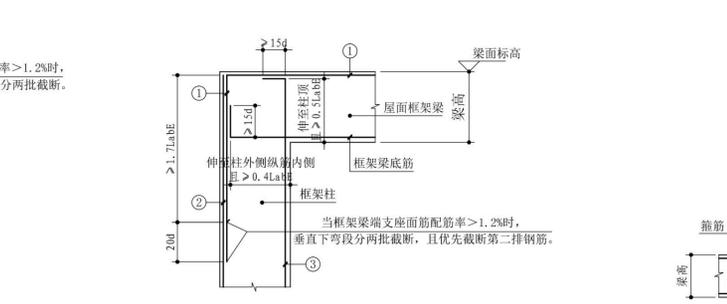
屋面框架梁纵向钢筋在顶层端支座构造大样
